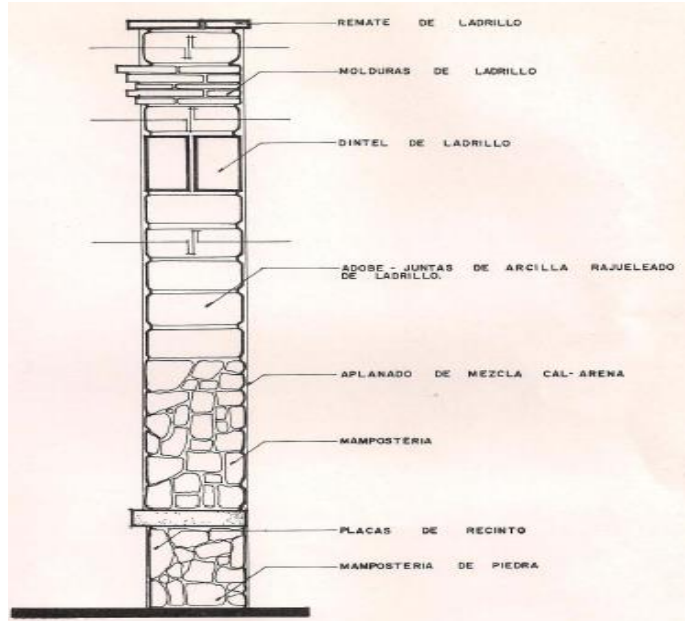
Detalle en mamposteado de piedra donde se aplica el aplanado de cal-arena.
